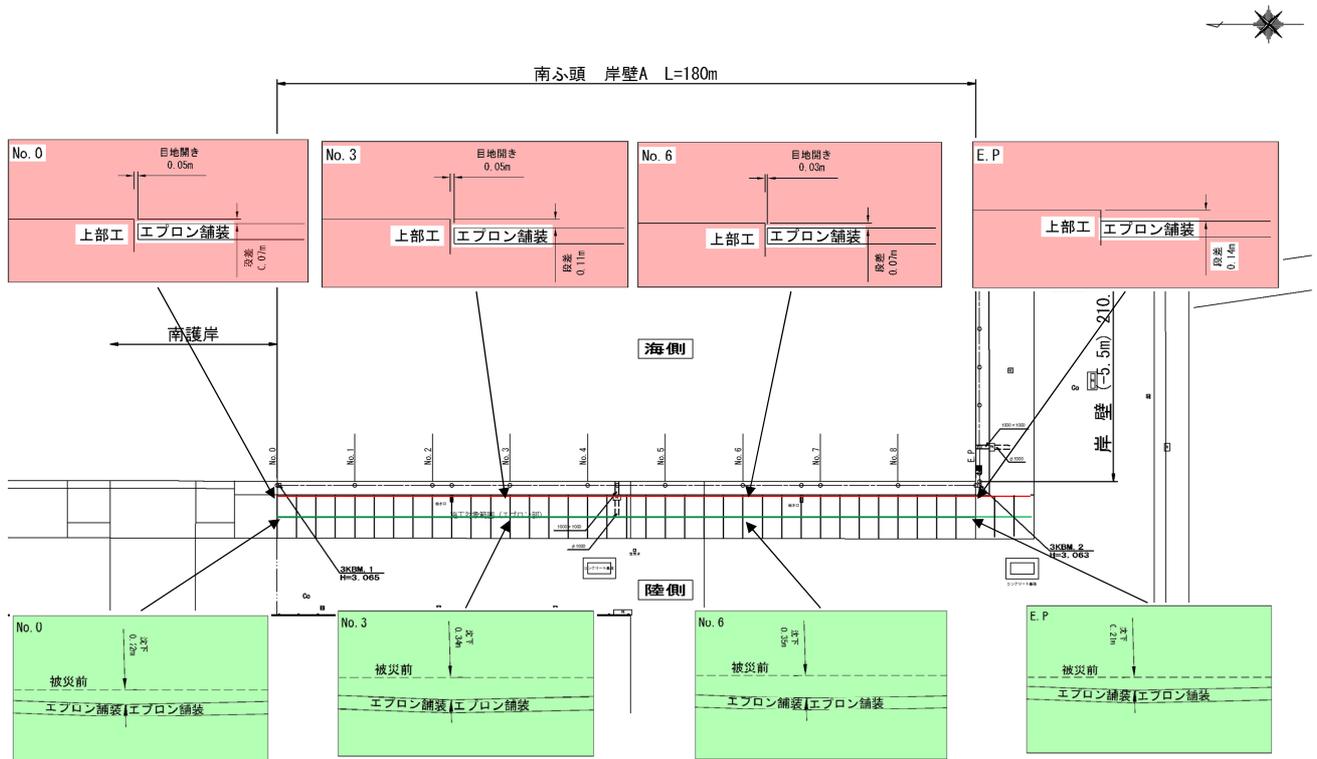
No.21 常陸那珂港区_南ふ頭地区 A 岸壁 (-5.5m) の平面図 (被災後)
